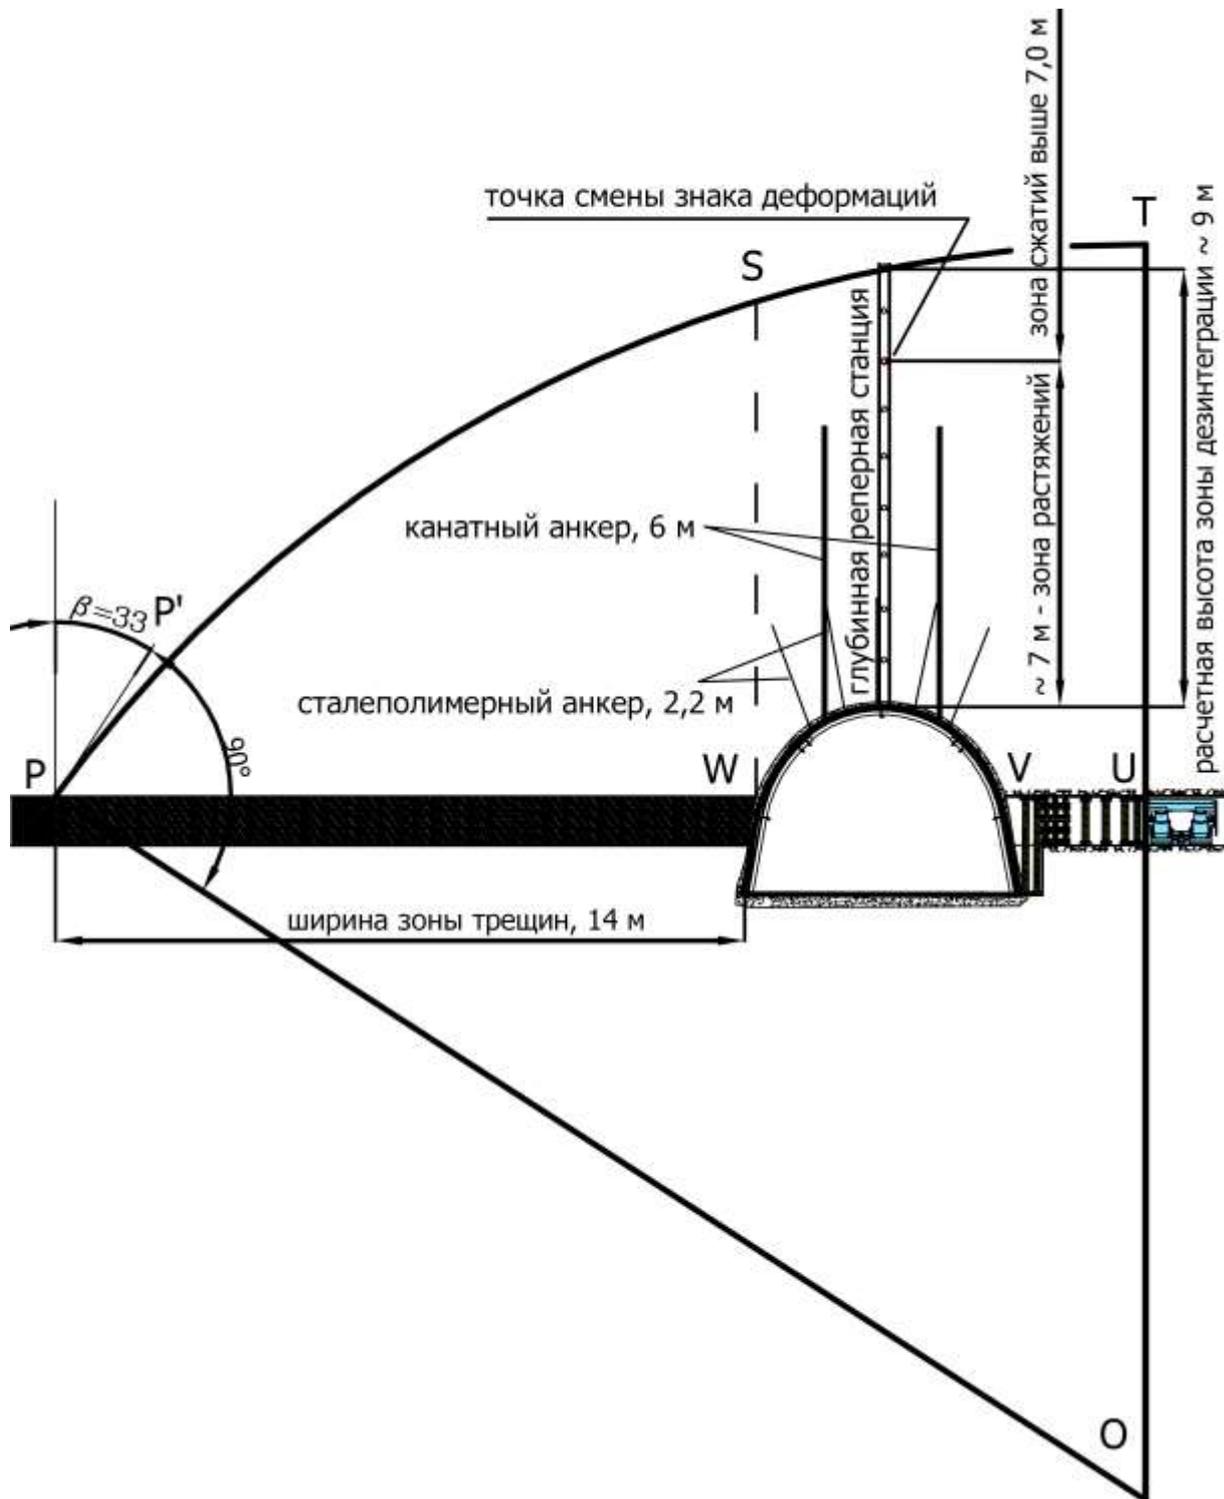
Схема к расчету нагрузки на крепь охраняемой выработки
